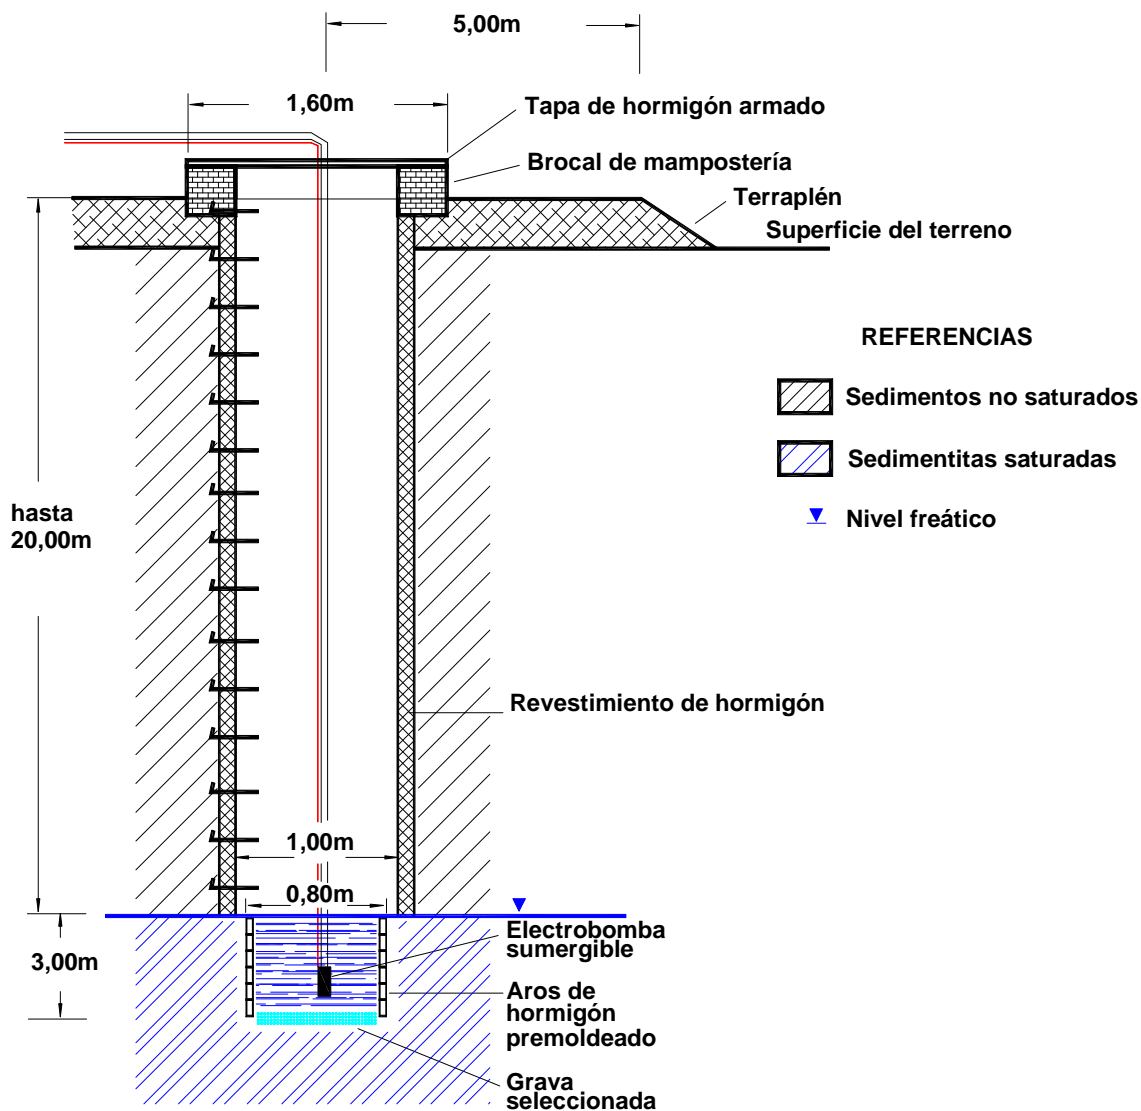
Croquis de vista en corte de un pozo excavado y calzado con revestimiento de hormigón y aros premoldeados en la zona saturada.
